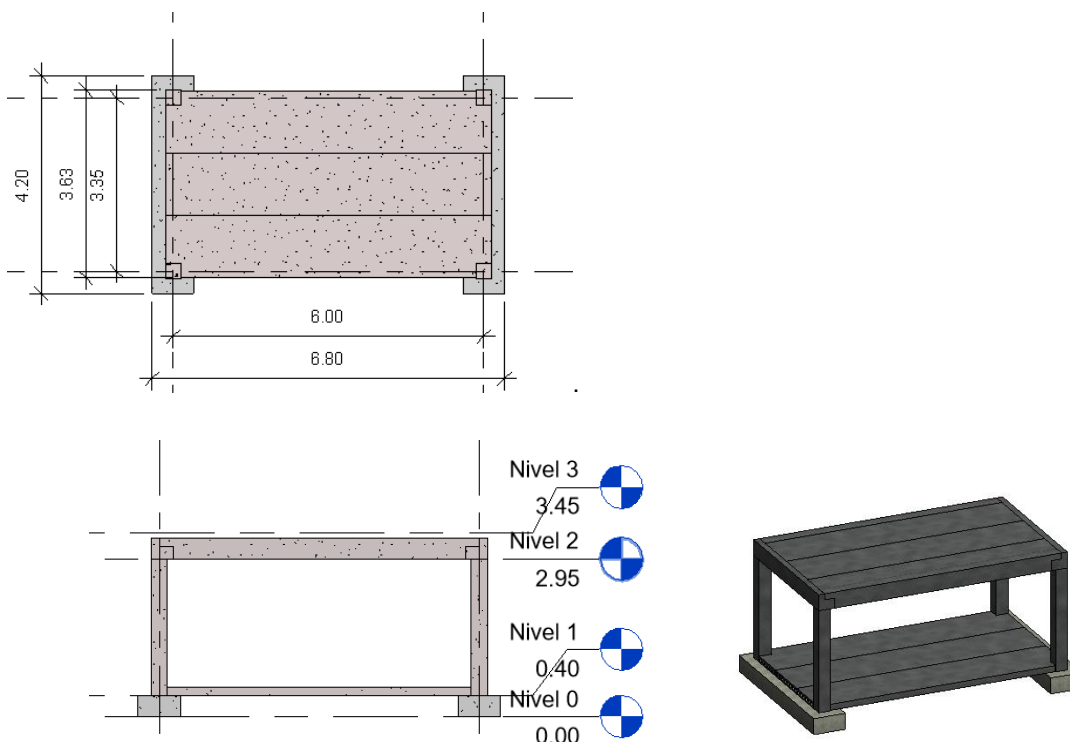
Plano, Alzado y el módulo en 3D. Fuente : Elaboración propia
